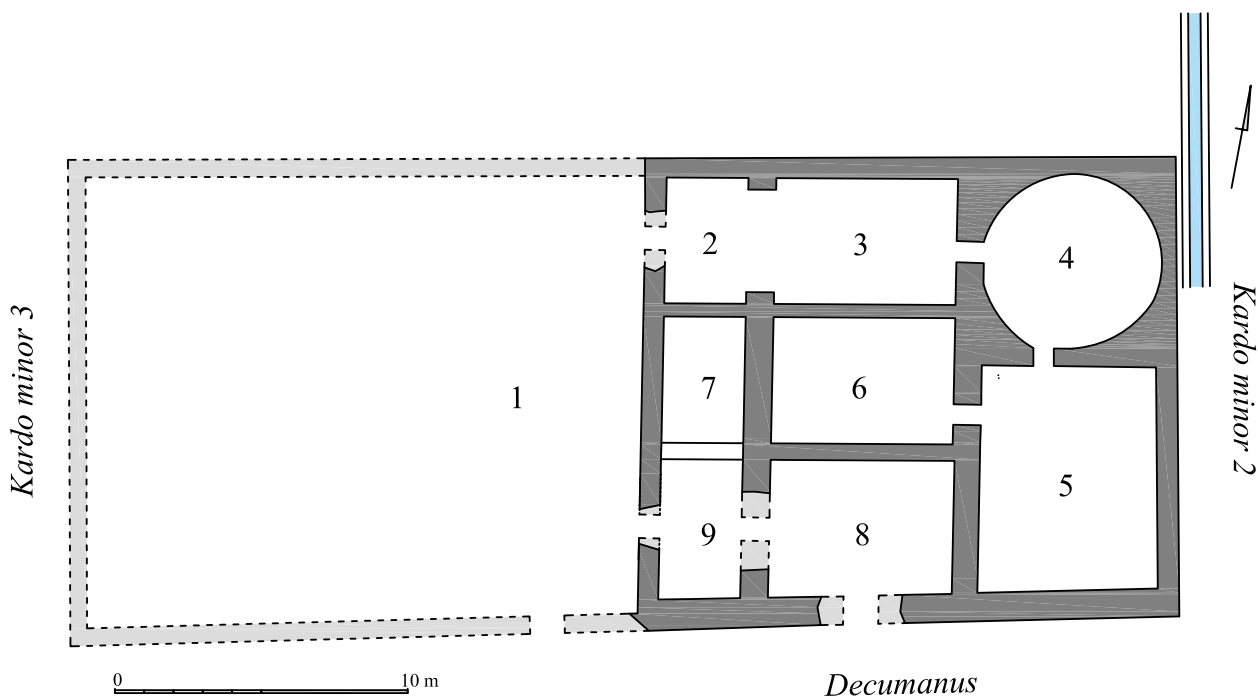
Planta esquemàtica del primer edifici termal: fase 1.
